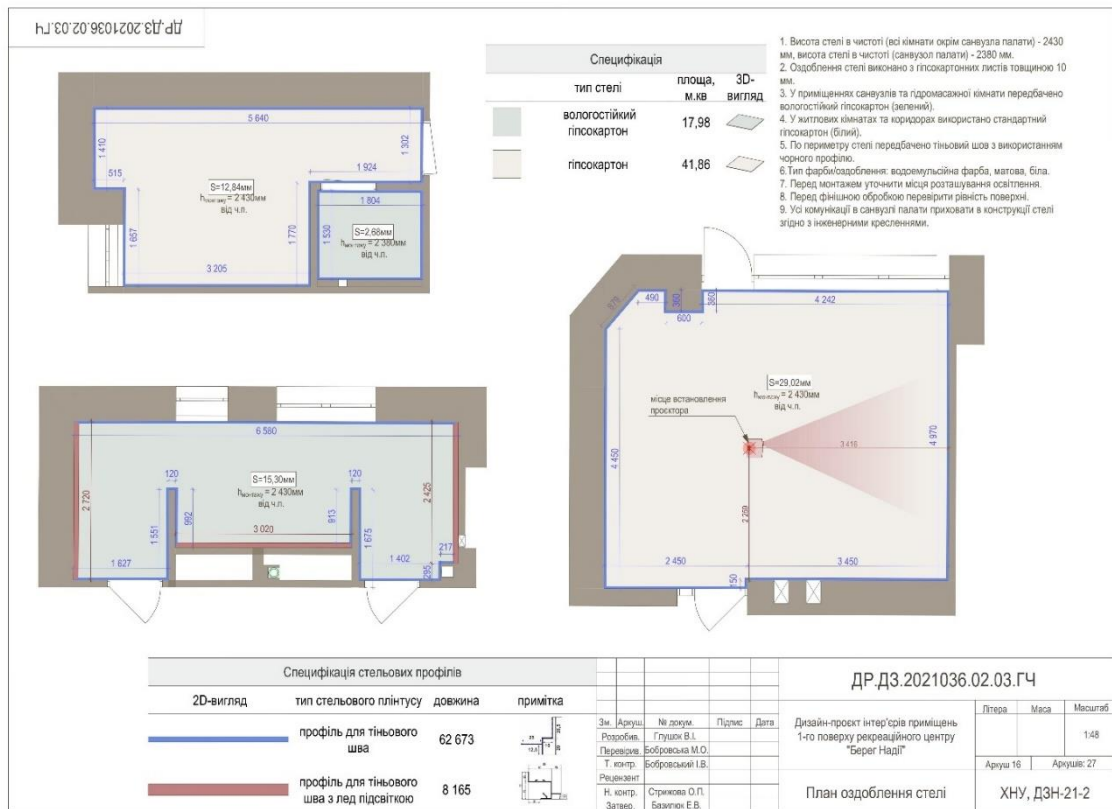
План оздоблення стелі кімнат першого поверху
